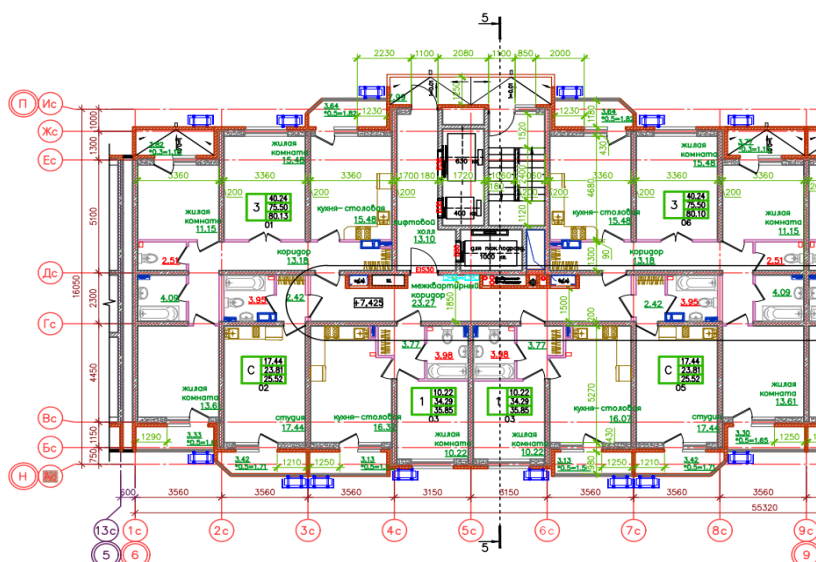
План 3 этажа БС-6 ЖК URAL
